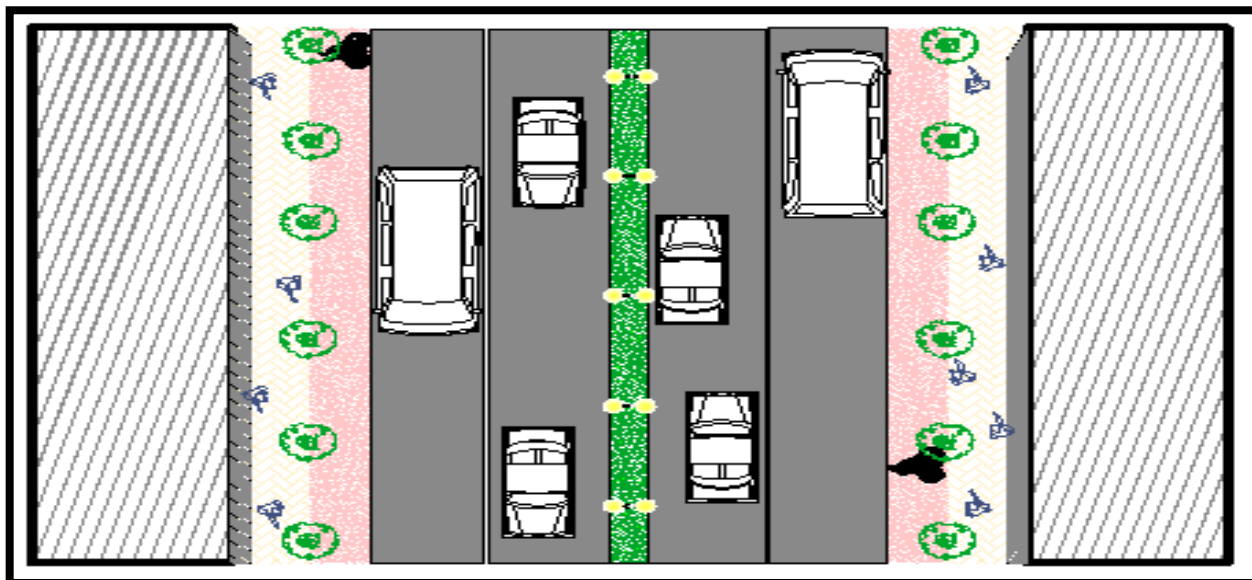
vue ne plan d'une voie secondaire (20m)
